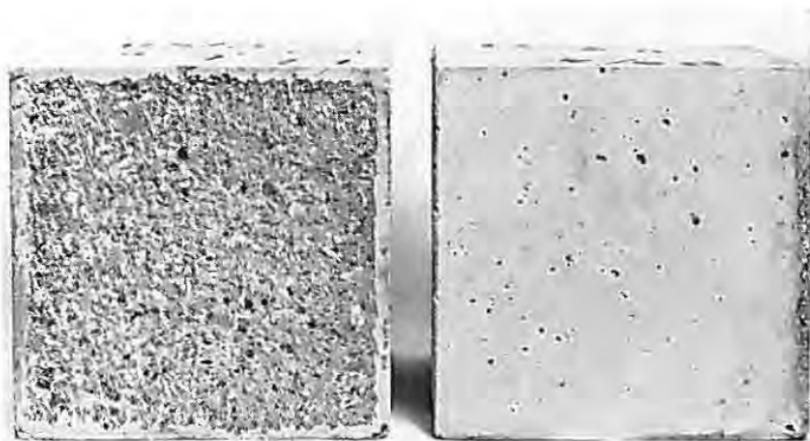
Aufgeraute und formglatte Würfel Druckflächen
